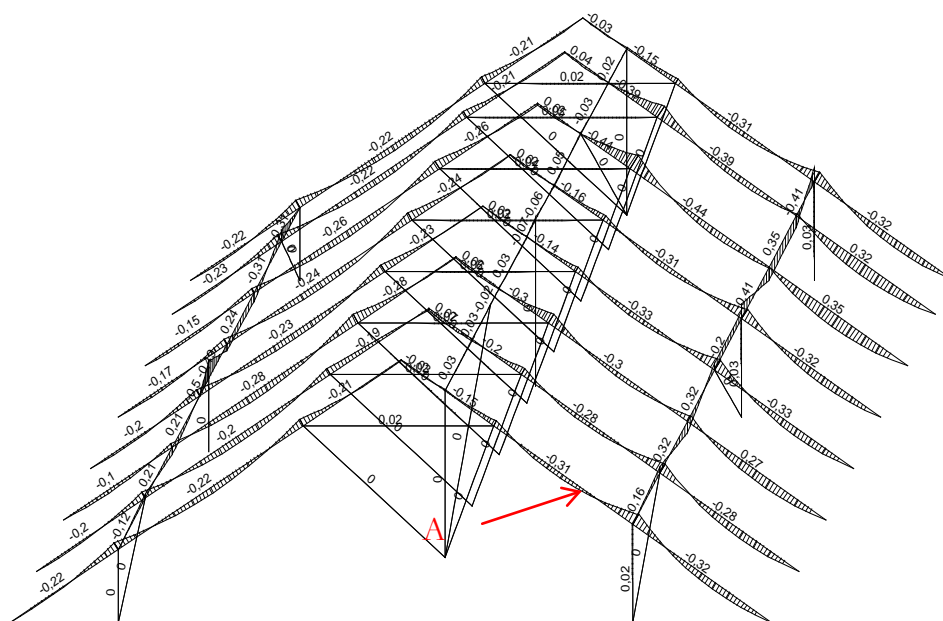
Эпюры внутренних усилий в поперечных сечениях стропильной системы с одной промежуточной стойкой (А) от расчетных значений нагрузки: а) эпюра продольных сил N , тс; б) эпюра изгибающих моментов M , т×м;
